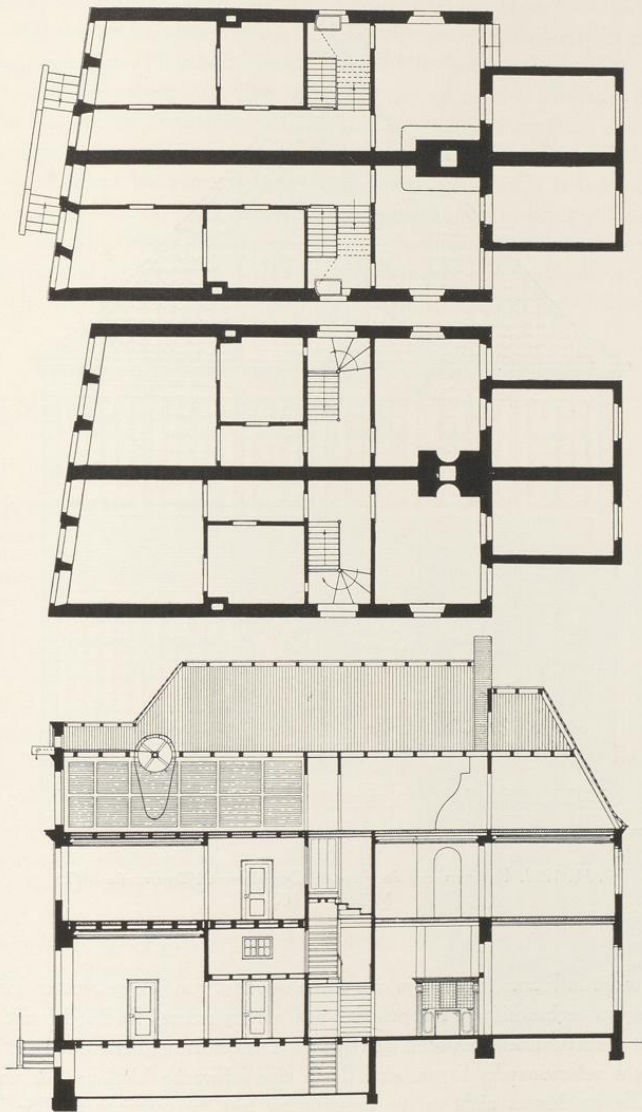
1231. Grundriß des Erd- und Obergeschosses und Schnitt durch das östliche Halbhaus Hörsterstraße 24/25. Maßstab 1 : 200
